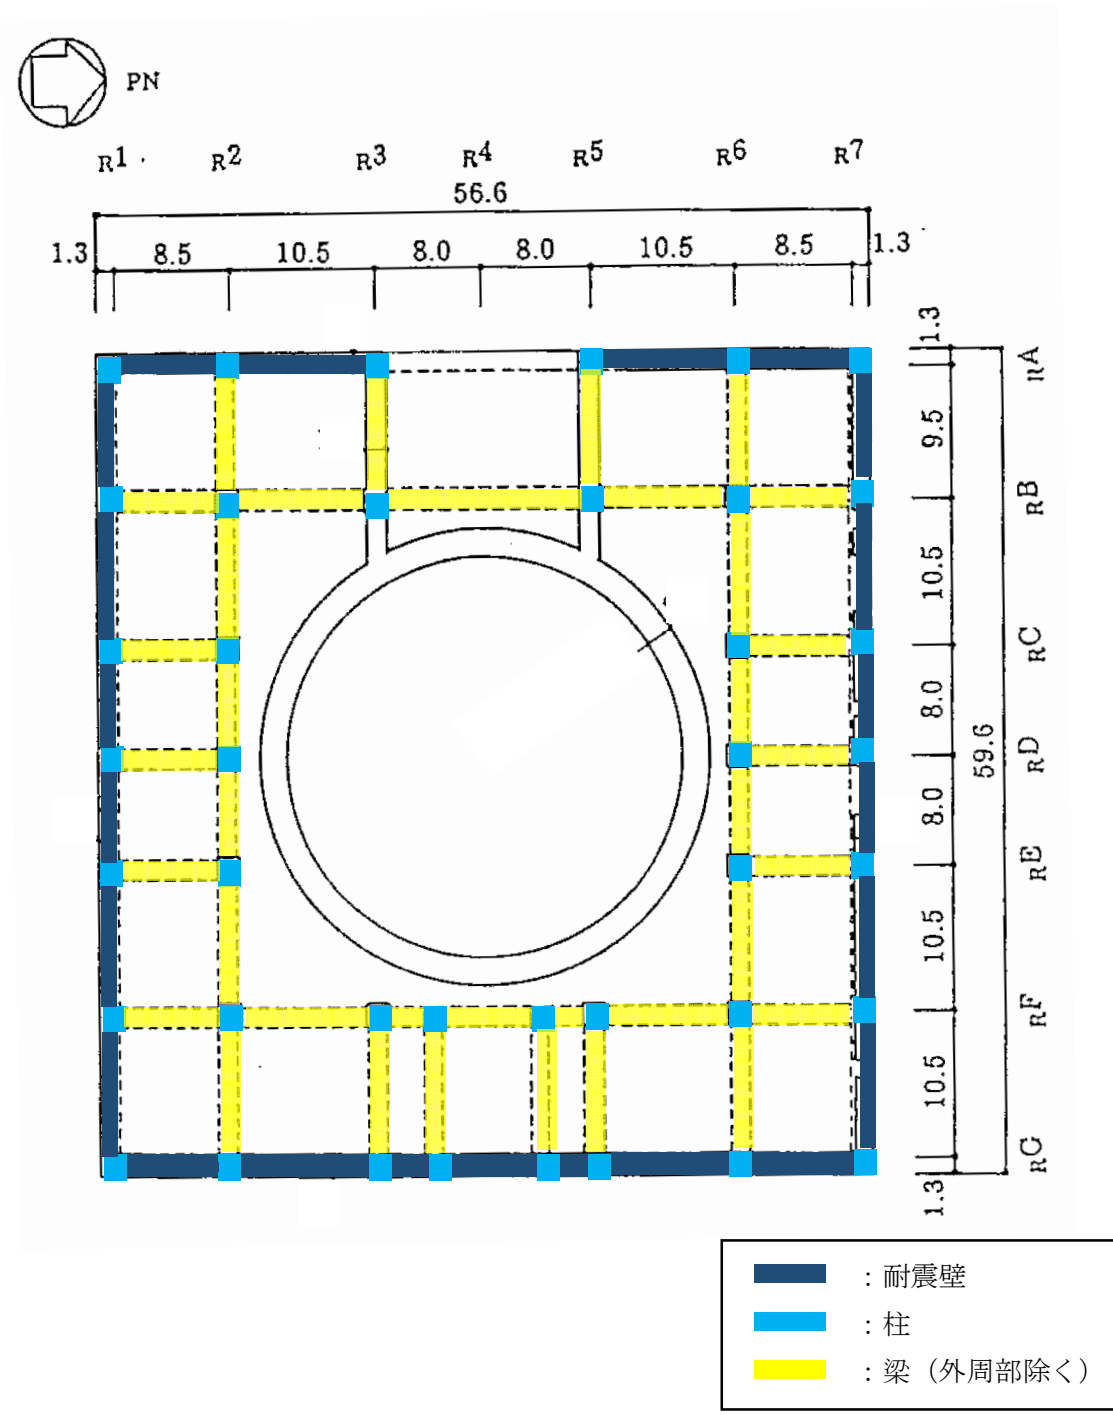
原子炉建屋 1 階伏図 (T.M.S.L.12.3) (单位 : m)
